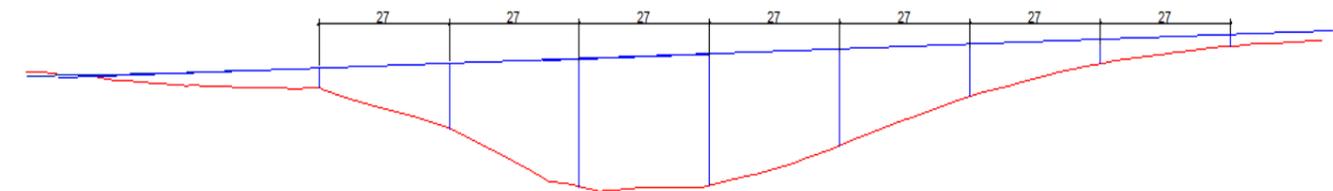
Propuesta de 7 vanos con luces de 27 metros.
